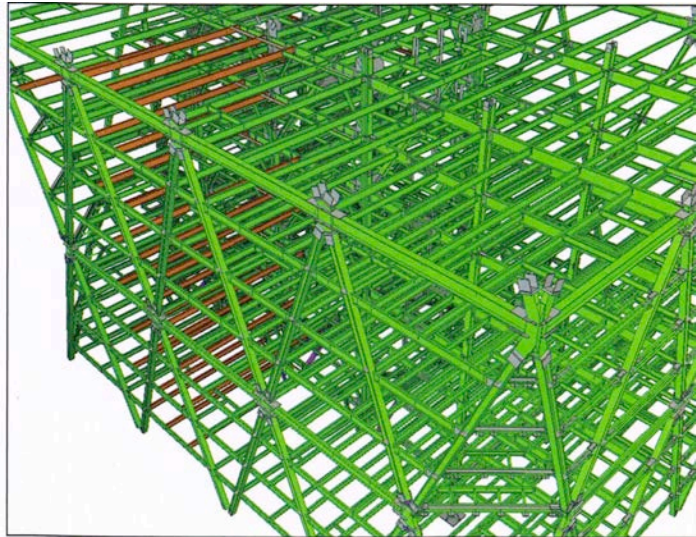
Detalle. Meyer Boake, T. (2014). *Diagrid structures: systems, connections, details
